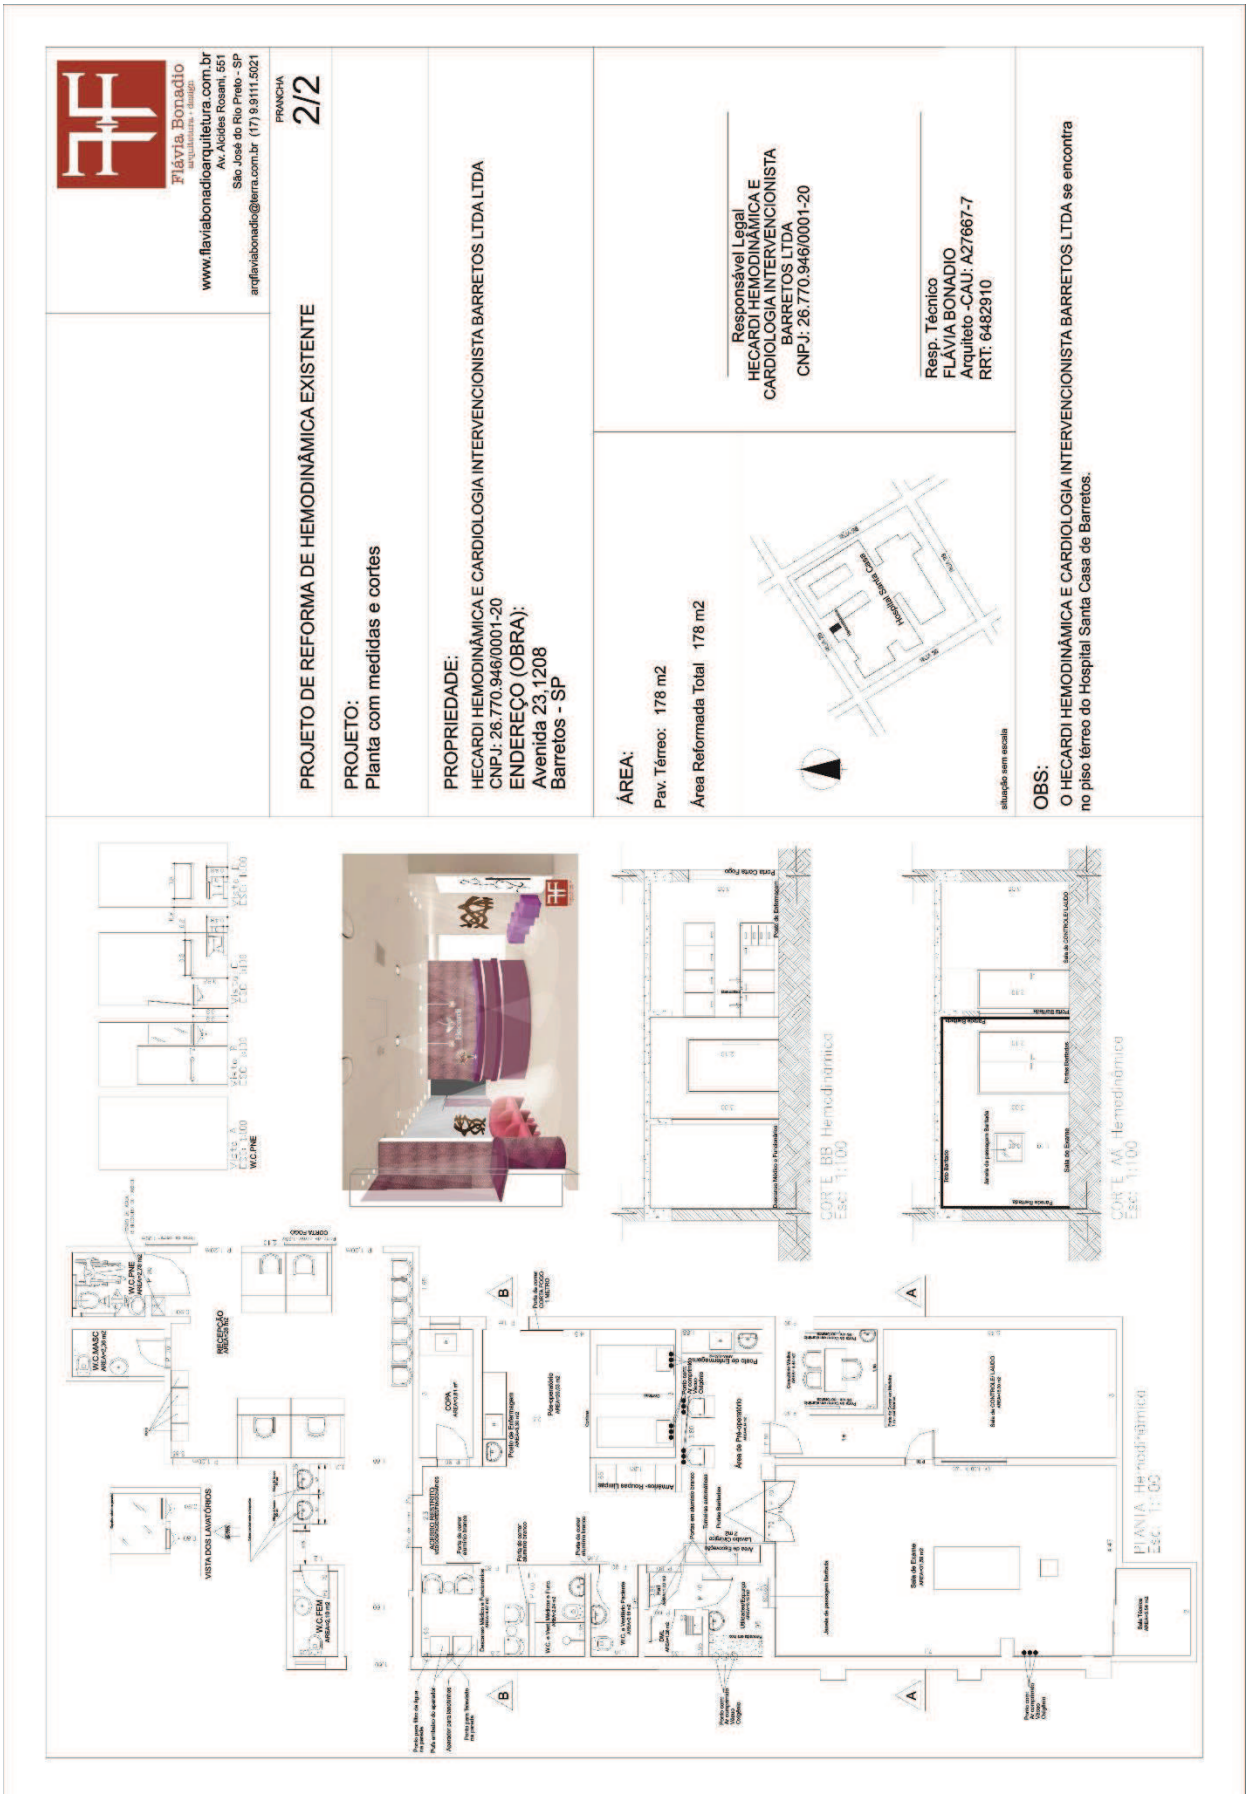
Prancha 02 – Projeto especificado Anvisa
